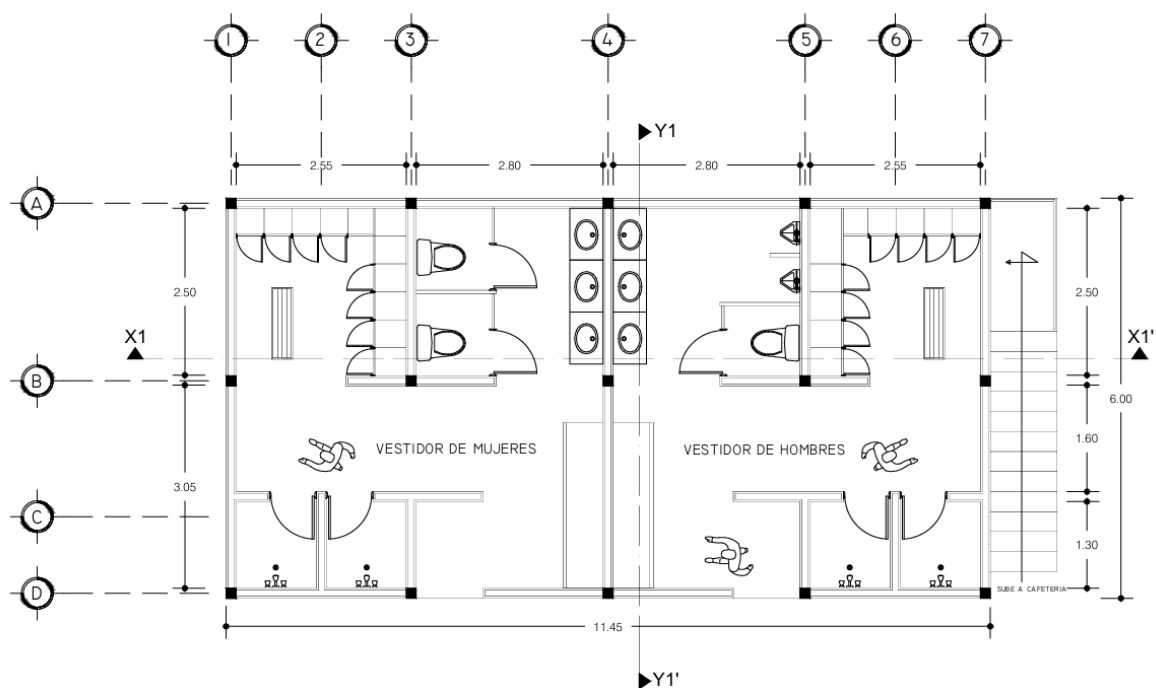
Arreglo general de cafetería y vestidores planta vestidores
